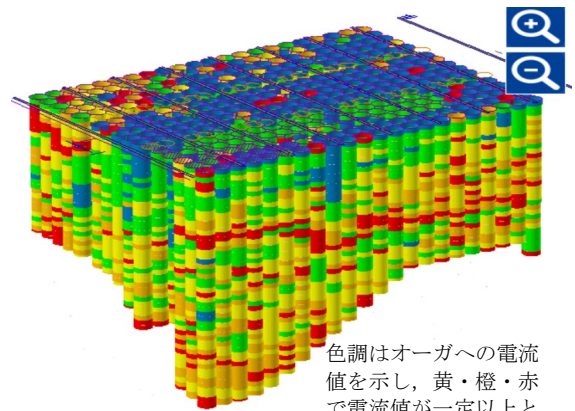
改良体配置図 (赤紫φ1.5m,赤φ1.6m)
